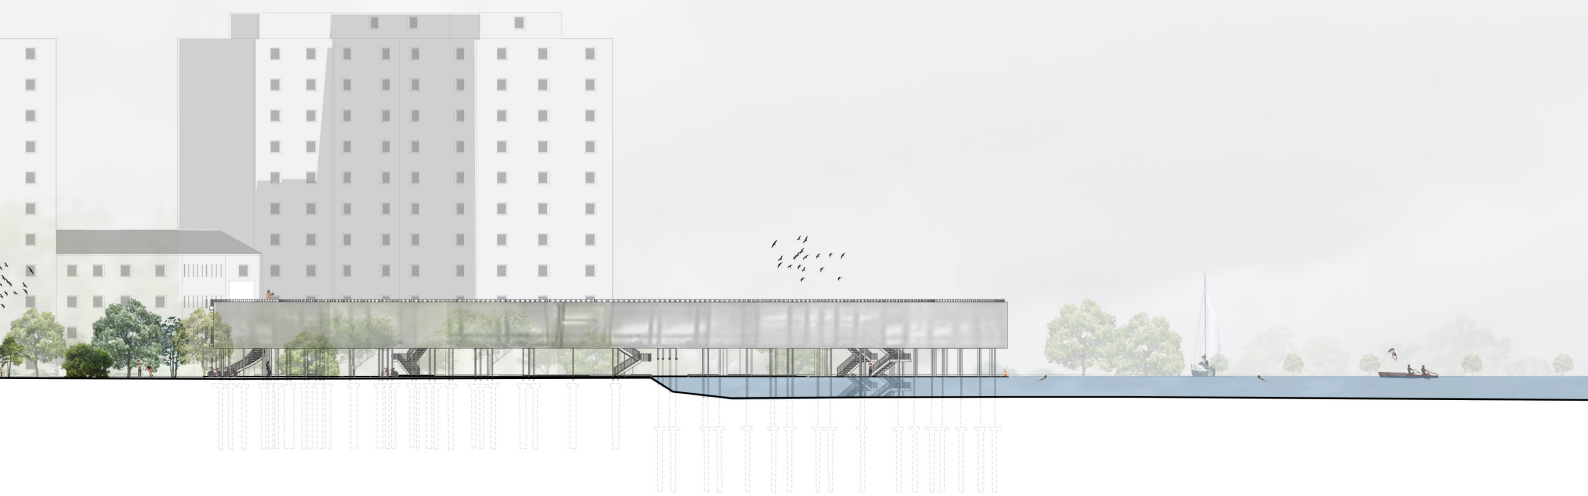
Vista da R. 20 de Abril para o Parque Ribeirinho.
